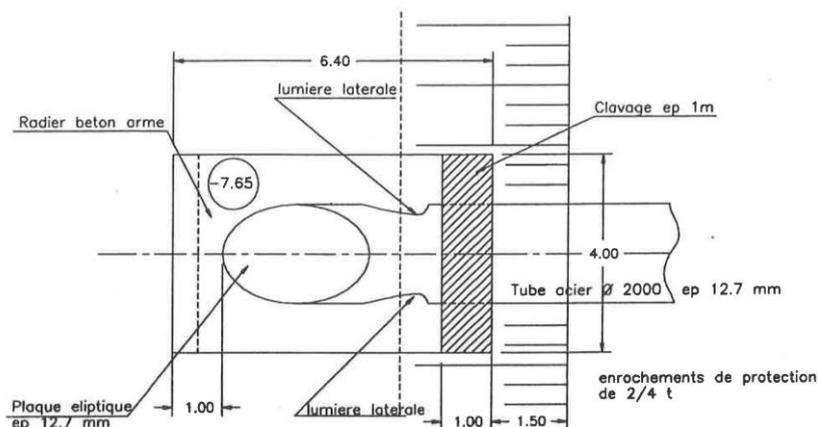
Vue en plan du Diffuseur (Source SPADA 1993)
